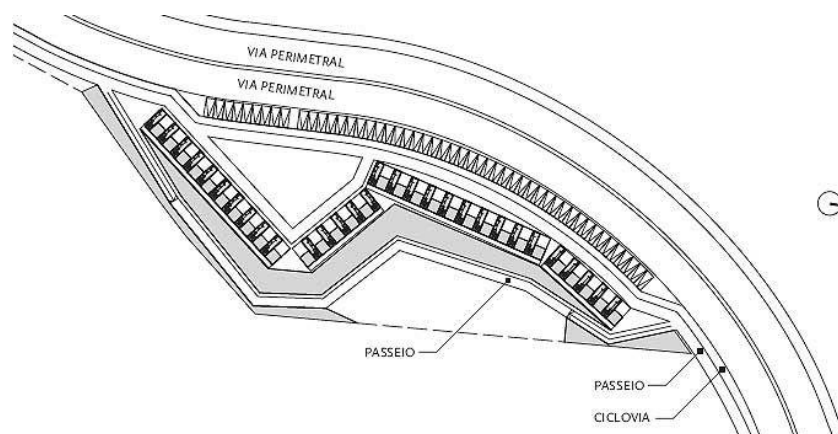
TERRENO DO PROJETO AVENIDA PERIMETRAL
